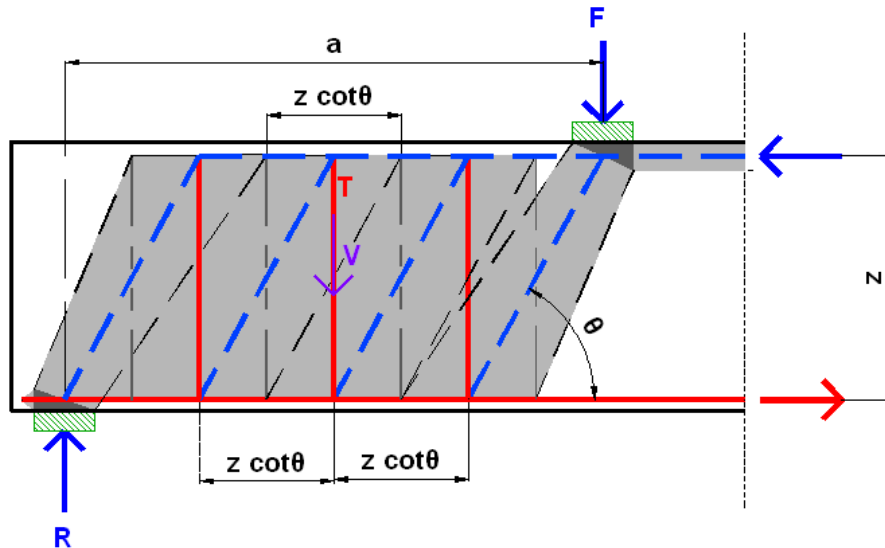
MET para Escora em região fissurada (acervo pessoal, 2016)
